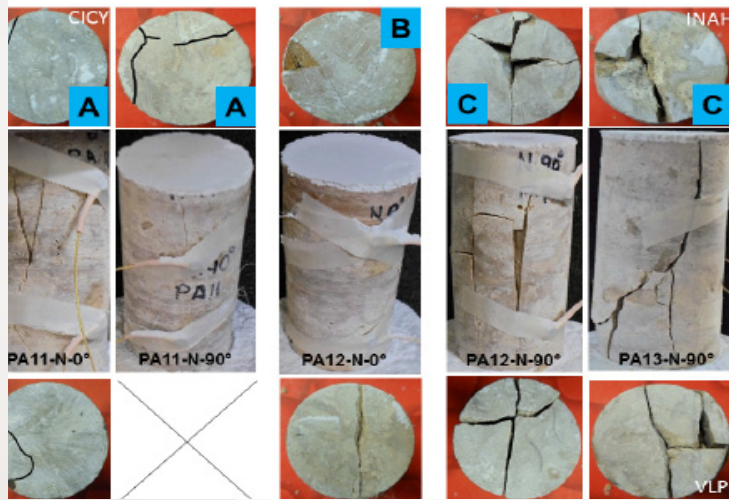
Representación de las fracturas y concentración de esfuerzos. A) Fractura lateral, B) Fractura a cortante, C) Fractura cortante - tensión.
